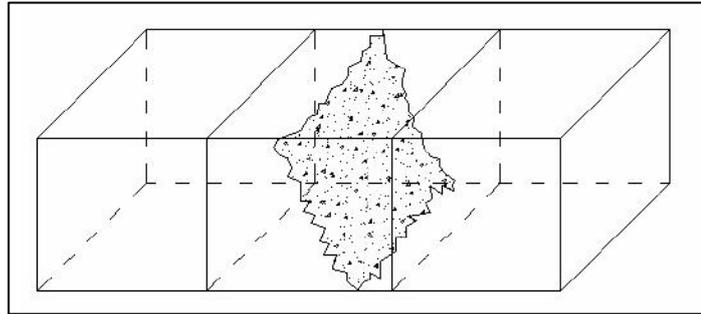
Pembebanan pada pengujian kuat tarik belah beton
